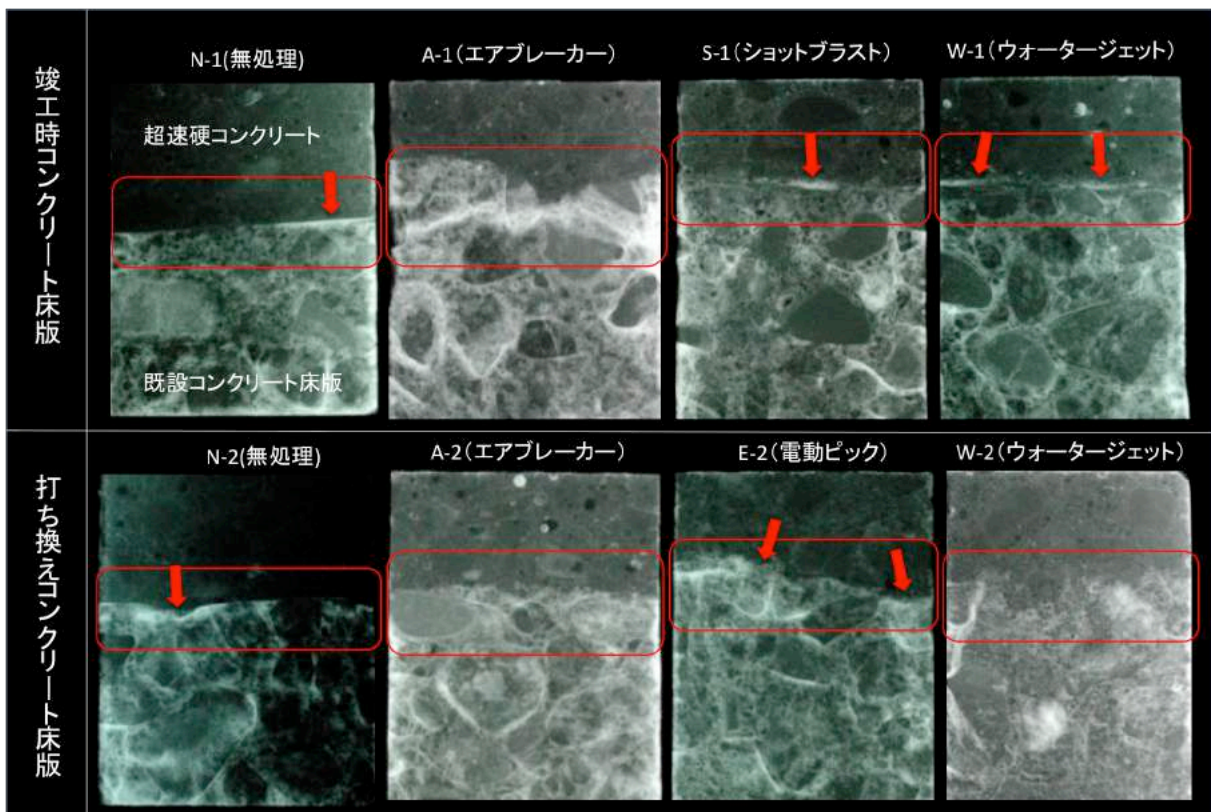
各種はつり方法によってコンクリート床版上層部に発生したひび割れ発生状況
